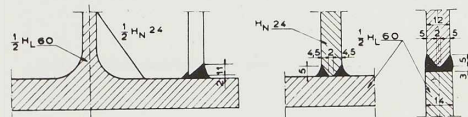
Détails de la soudure des raidisseurs et (à droite) de l'assemblage des demi-poutrelles constituant membrures avec l'âme de la poutre.
